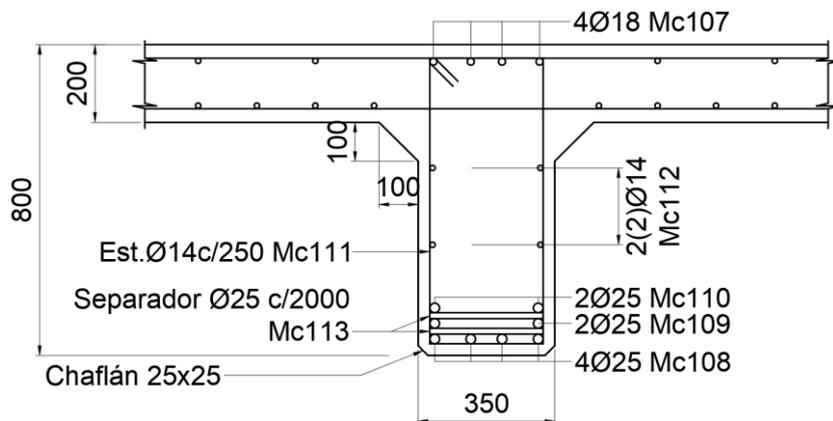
Sección transversal de la viga H.A, corte 1-1' [Elaboración propia]
